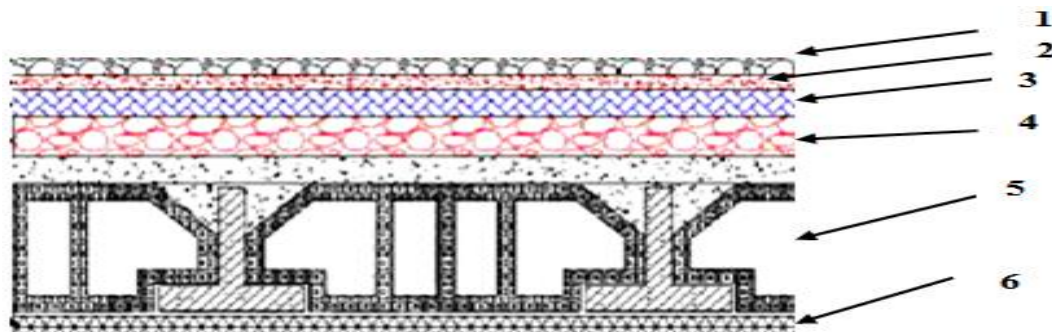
coupe d'un plancher à corps creux du plancher terrasse.
